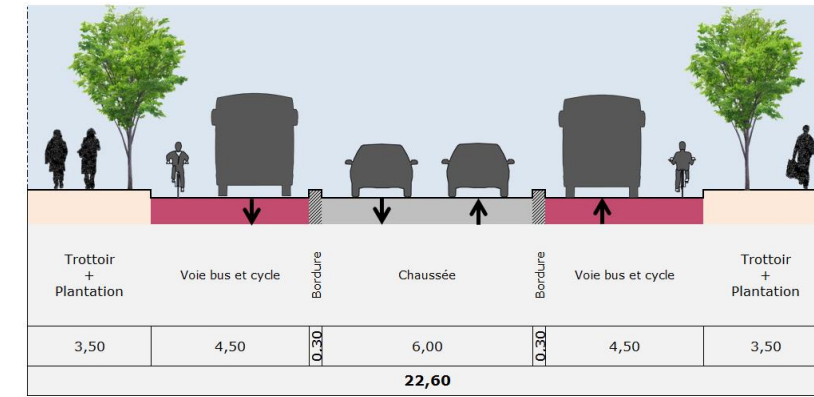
Coupe type pour l'insertion d'un site propre bilatéral
